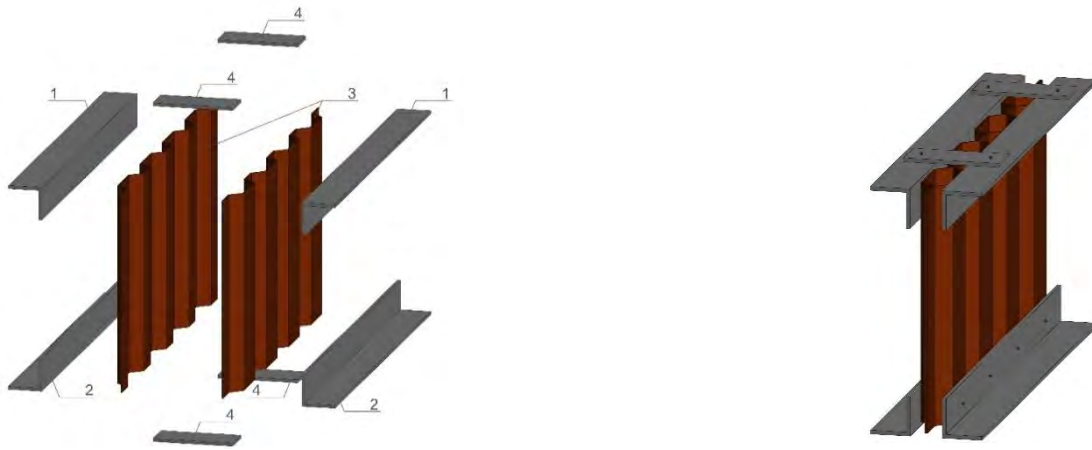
Схема сборной балки с гофрированной стенкой: 1 – элементы верхнего пояса, 2 – элементы нижнего пояса, 3 – гофрированная стенка, 4 – планки
